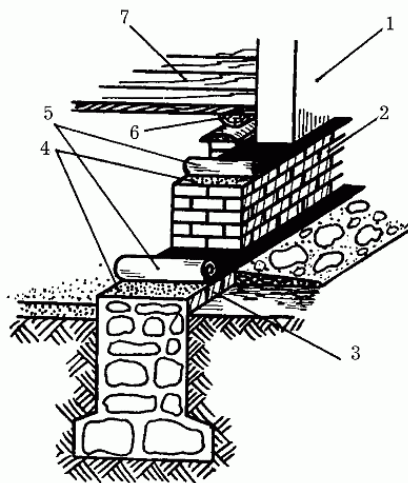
Ленточный фундамент: 1 – стена; 2 – цоколь; 3 – отмостка; 4 – цементный раствор; 5 – гидроизоляционный материал; 6 – лага; 7 – пол
